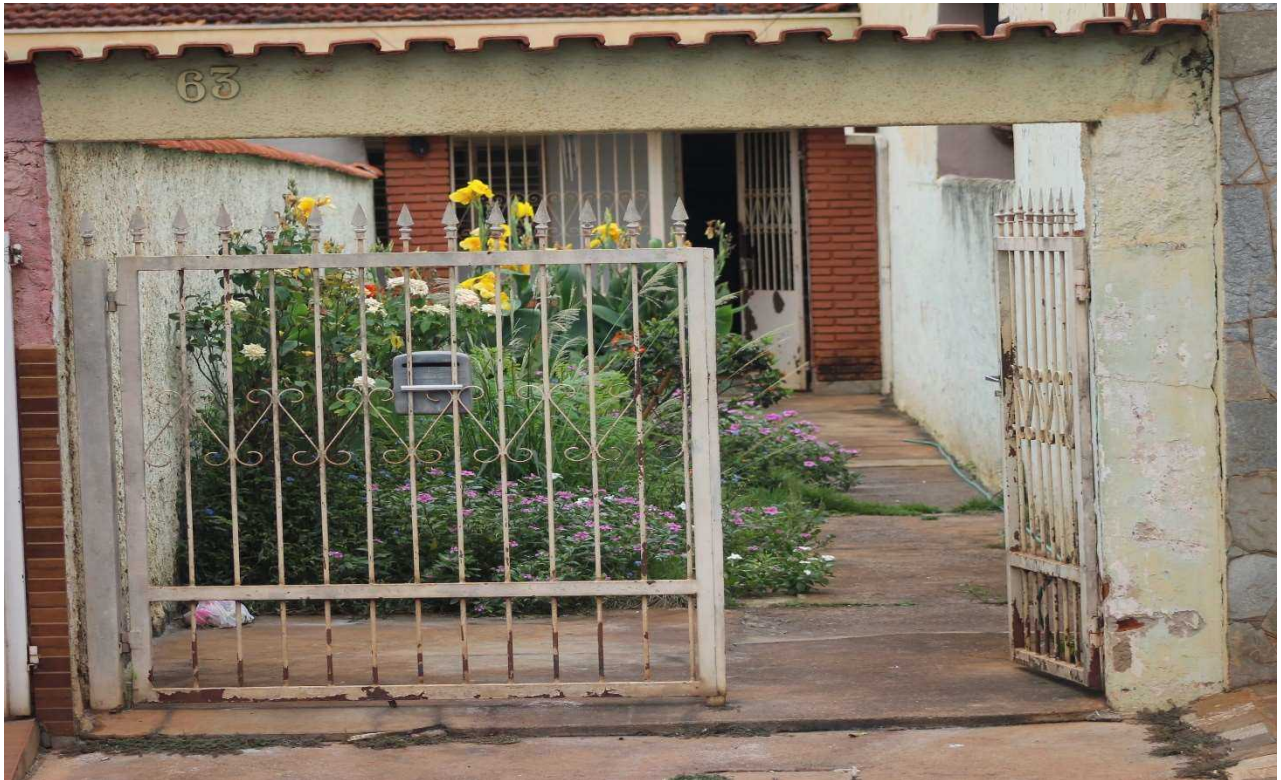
Fachada do Imóvel ser avaliado na Rua Antonio Soares Castilho, nº63, Jardim Antartica
